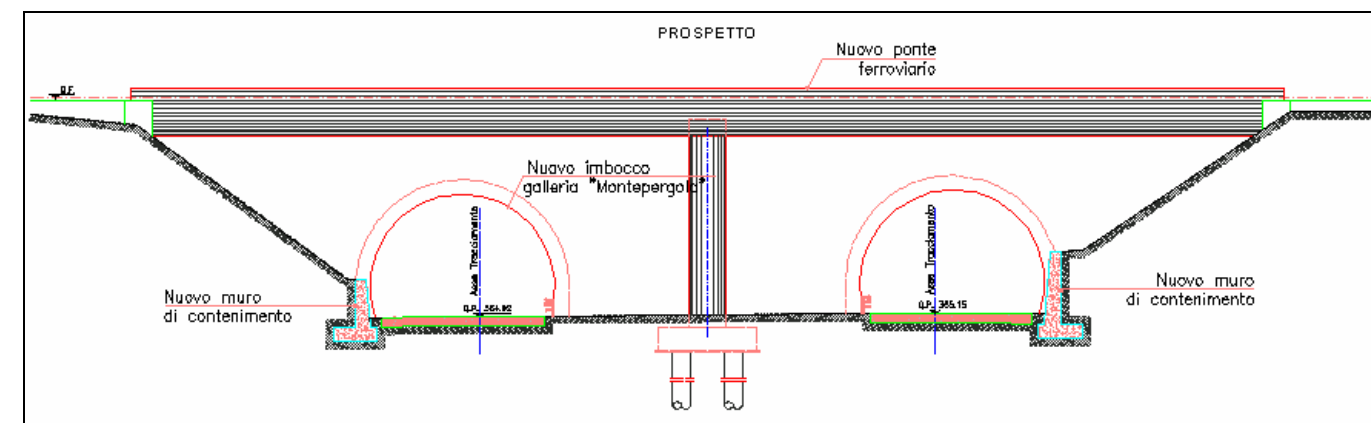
Prospetto del nuovo ponte ferroviario
